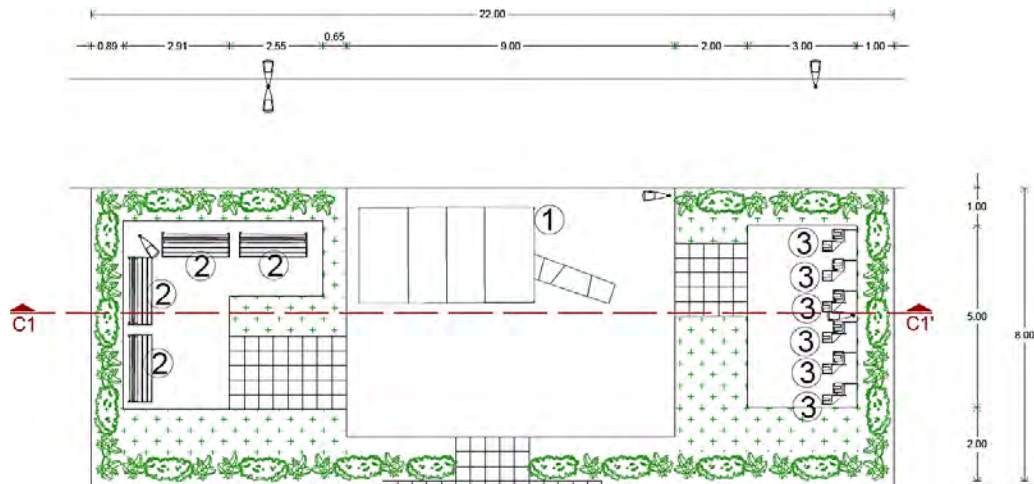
Planta arquitectónica de la parada de autobús, se observa la ubicación del mobiliario y los cambios de pavimento utilizados para delimitar las áreas.
